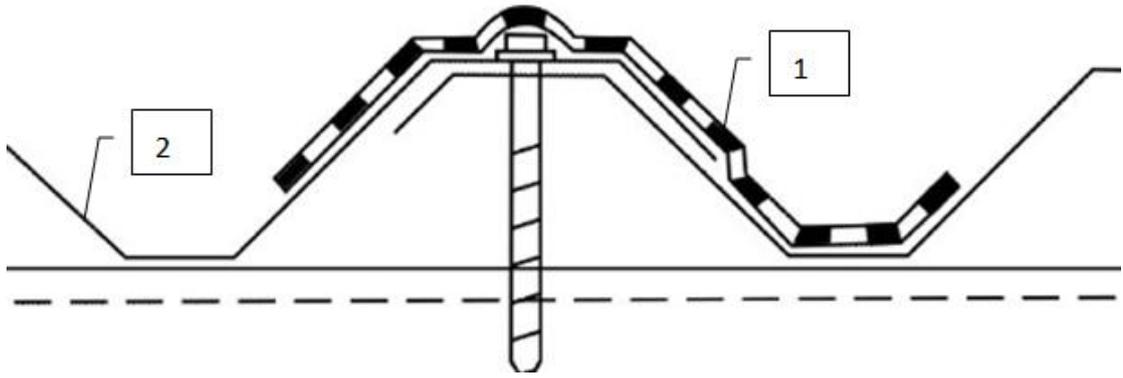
金属屋面板搭接竖缝防水结构示意图
